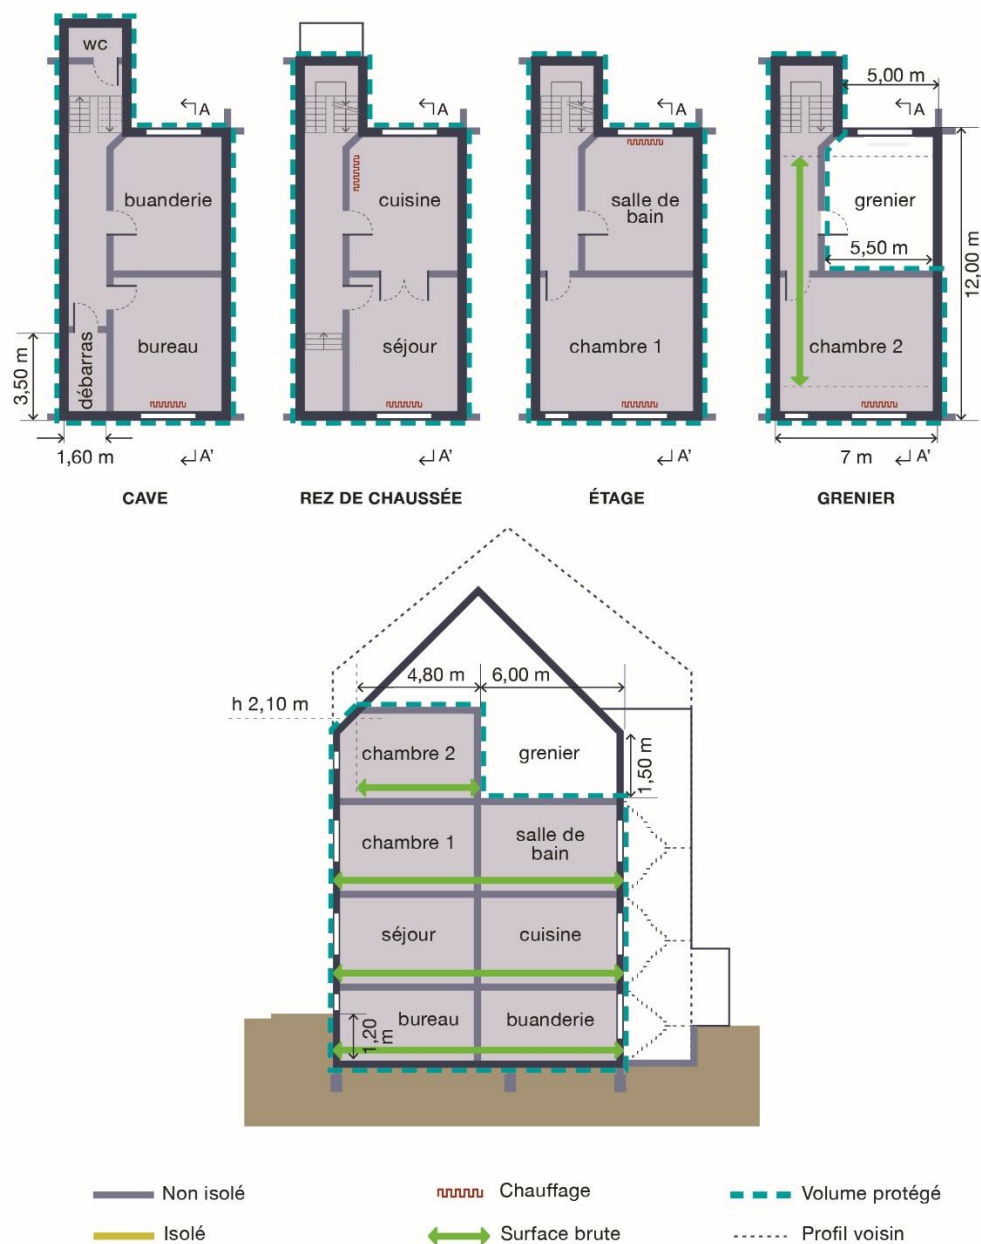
Vue en plan et en coupe d'une maison bourgeoise
